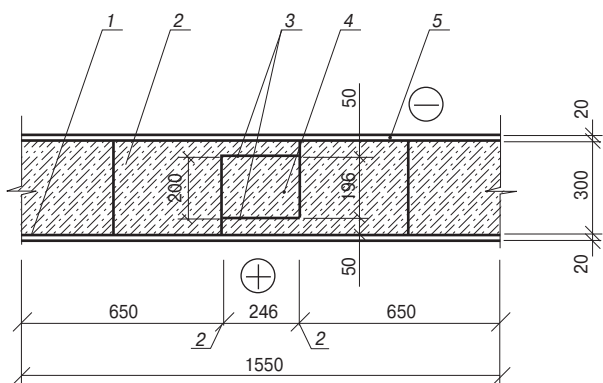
Схема стенового ограждения: 1 – известково-песчаный раствор; 2 – полистиролбетон; 3 – керамическое теплоизоляционное покрытие; 4 – керамзитобетон; 5 – цементно-песчаный раствор
